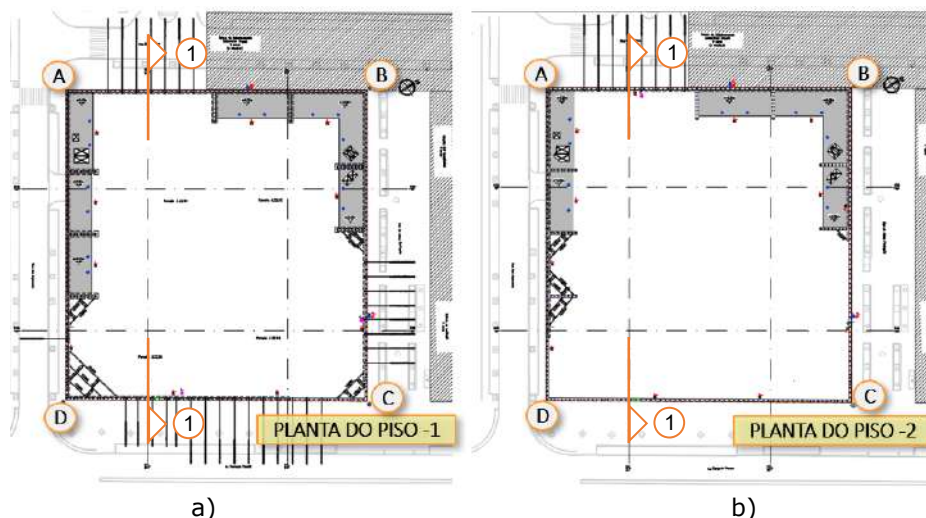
Plantas de dimensionamento da estrutura de contenção periférica e dos travamentos ao nível do piso -1 (a) e do piso -2 (b).
